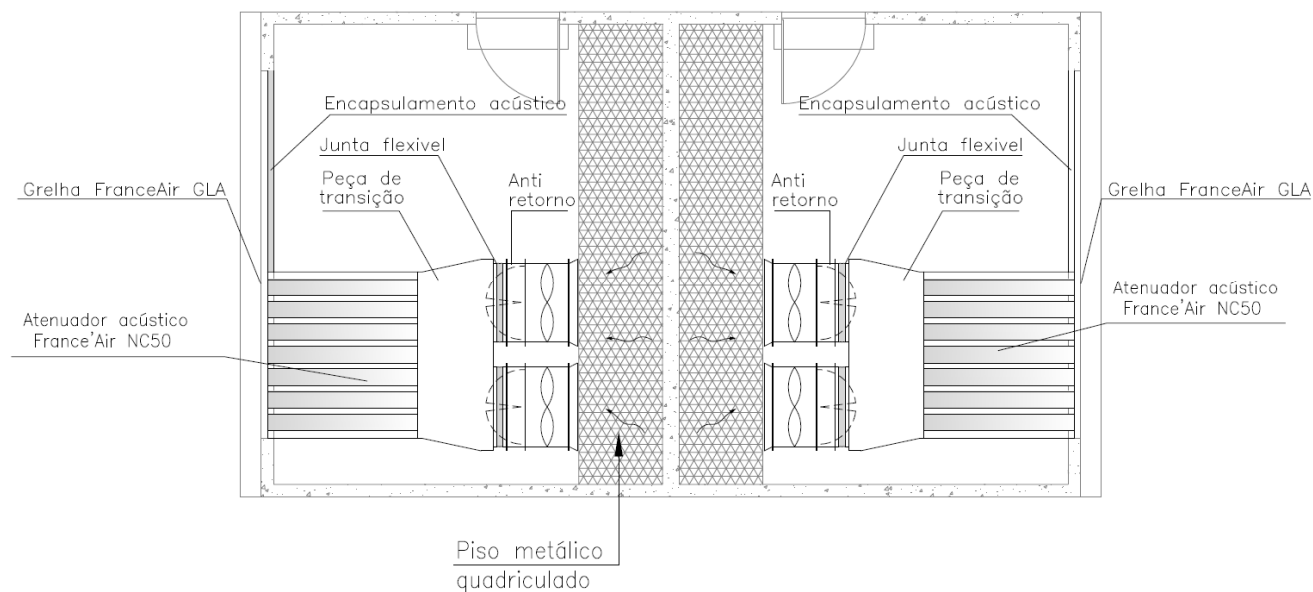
Planta das áreas abrangidas do sistema de insonorização – Salas de Transformação
